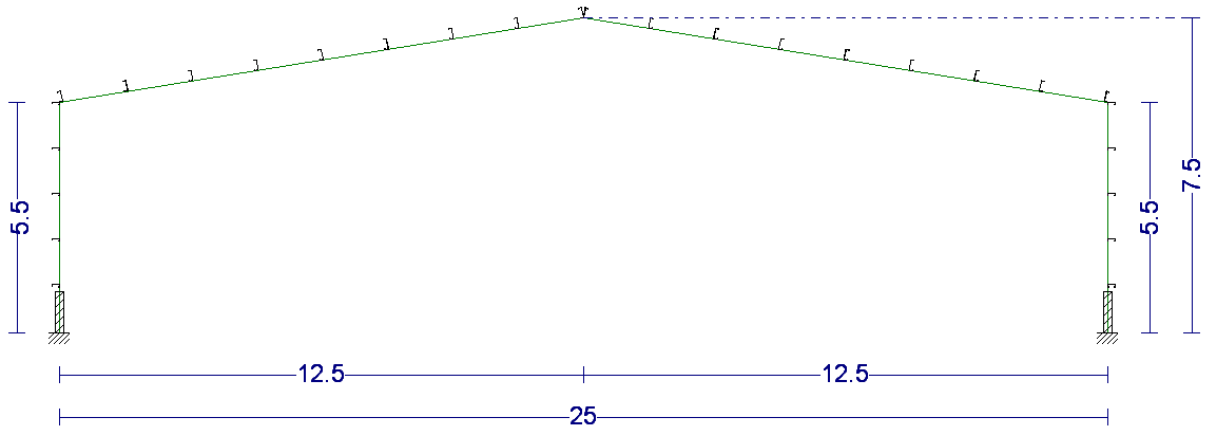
Geometría pórtico tipo junto a las disposiciones de correas y muro de contención (CYPE, 2014).
